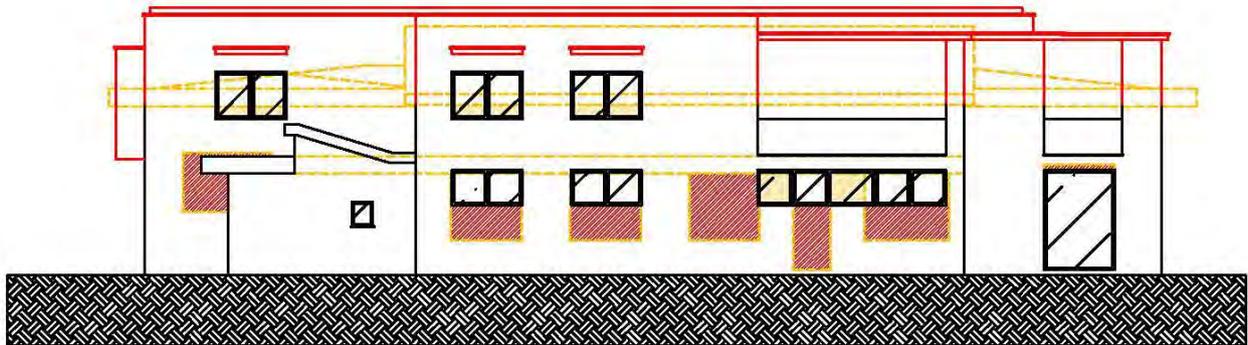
Tipologia di progetto prospetto ovest tato sovrapposto.
